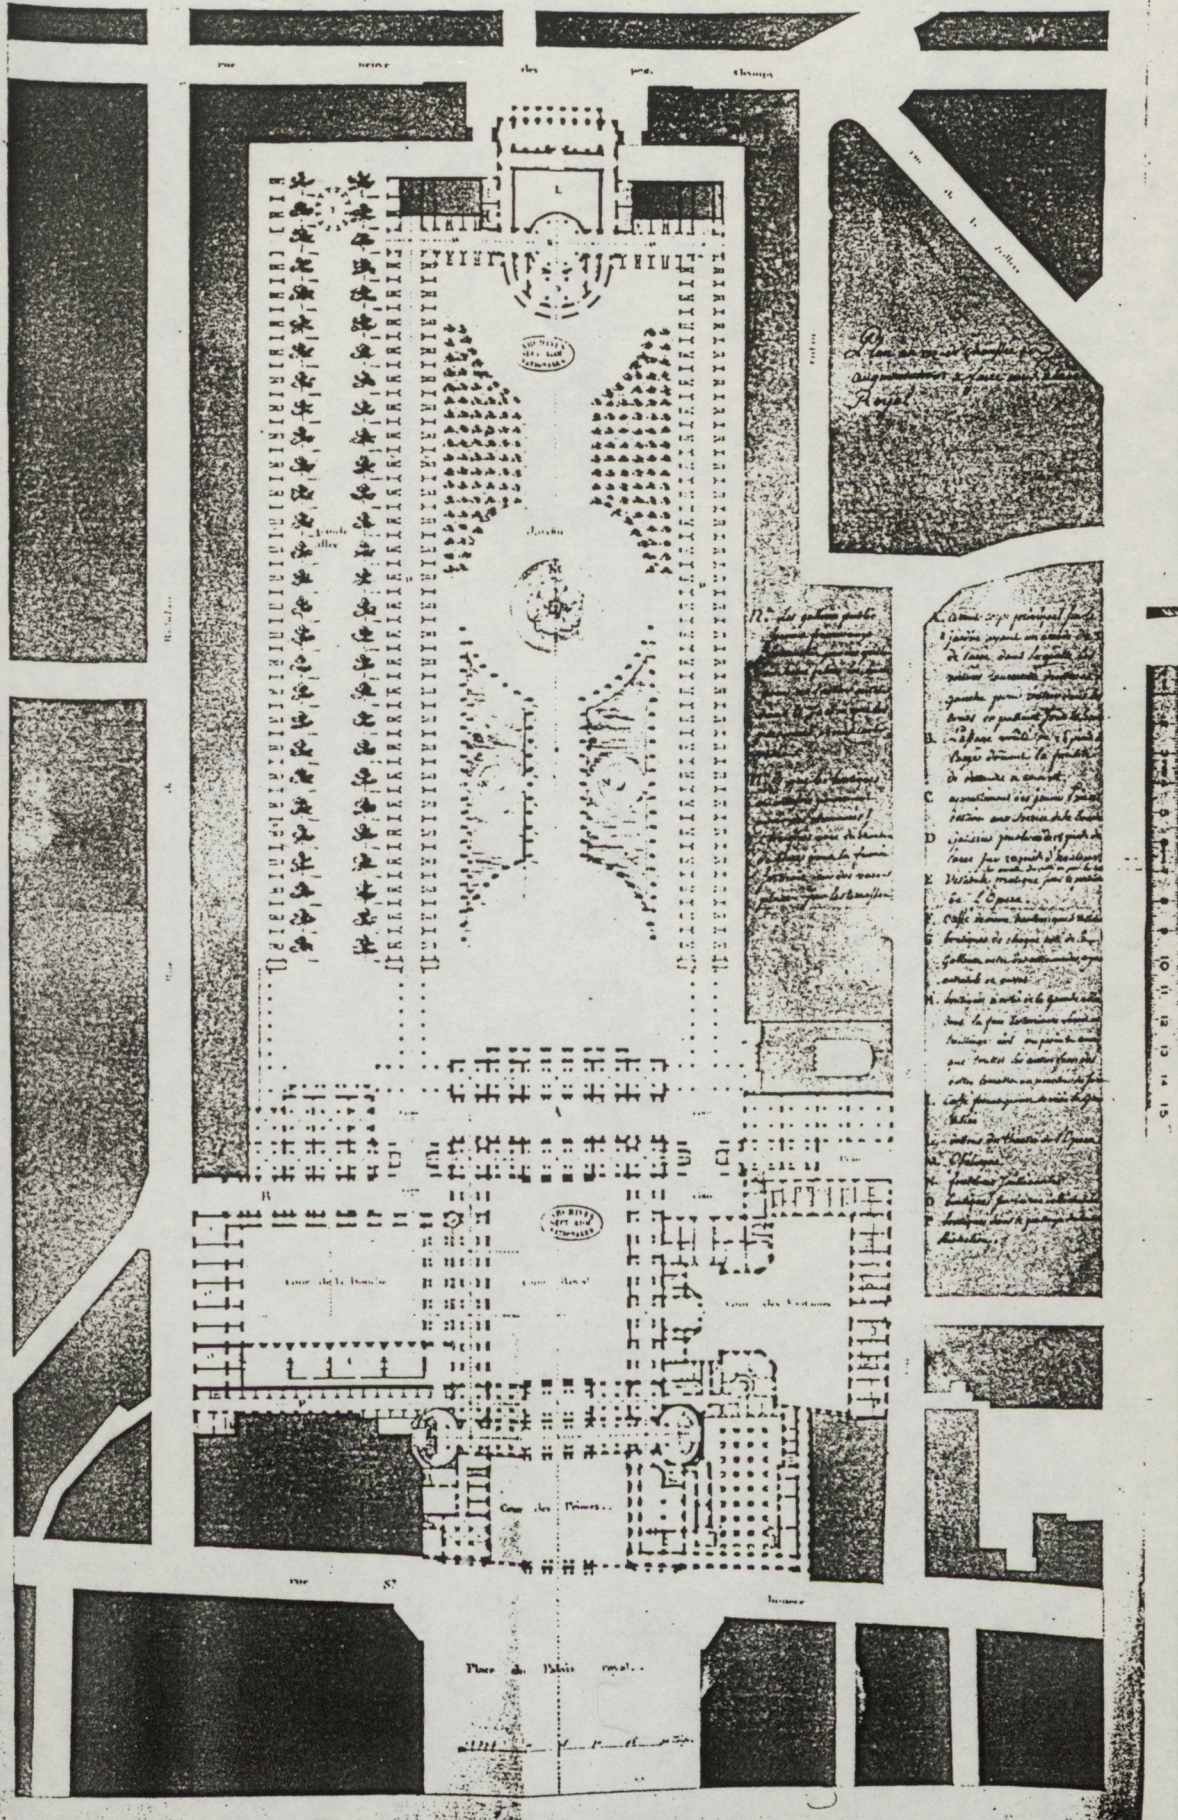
"Plan au rez-de-chaussée des augmentations à faire au Palais-Royal" (s.d.)
